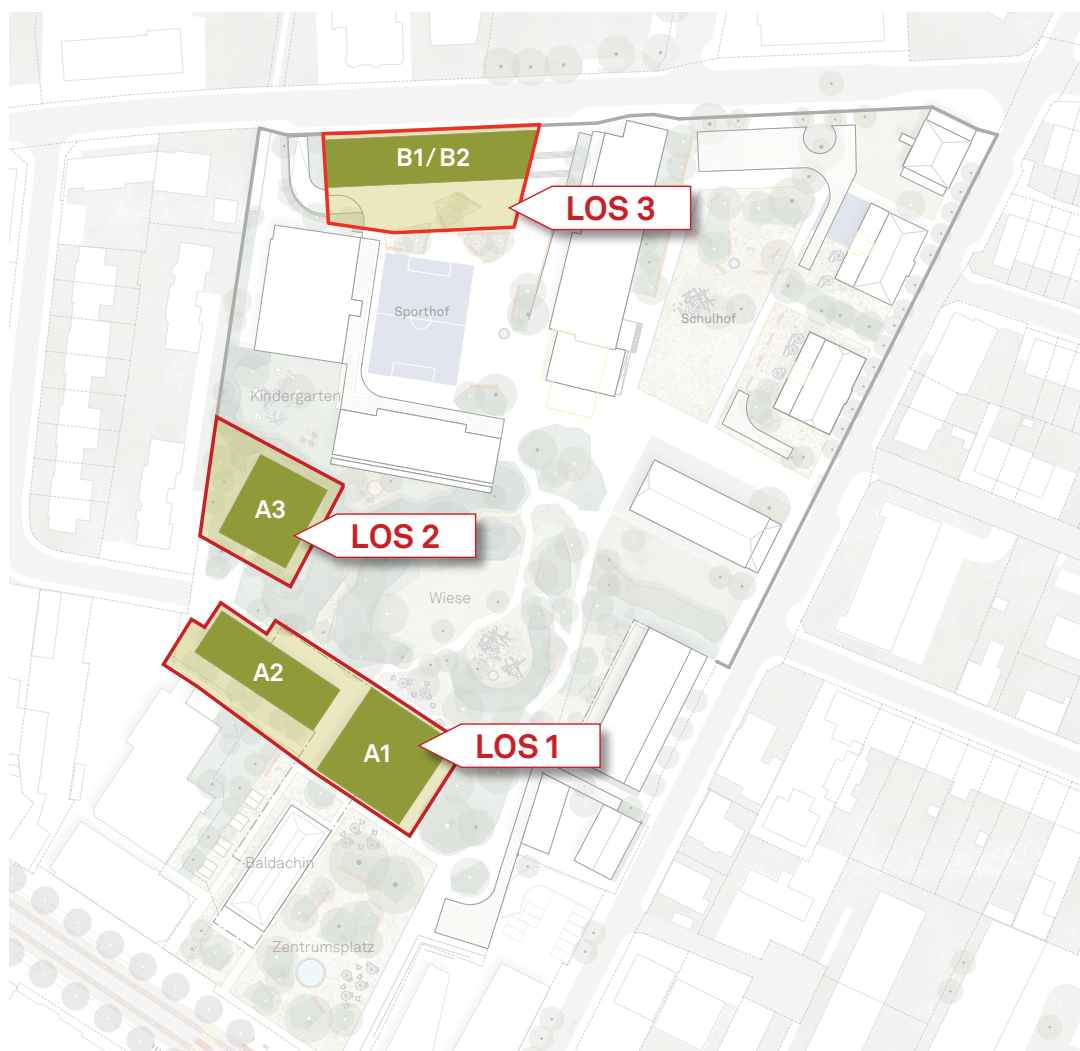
Im Baurecht abzugebende Baurechtsparzellen
